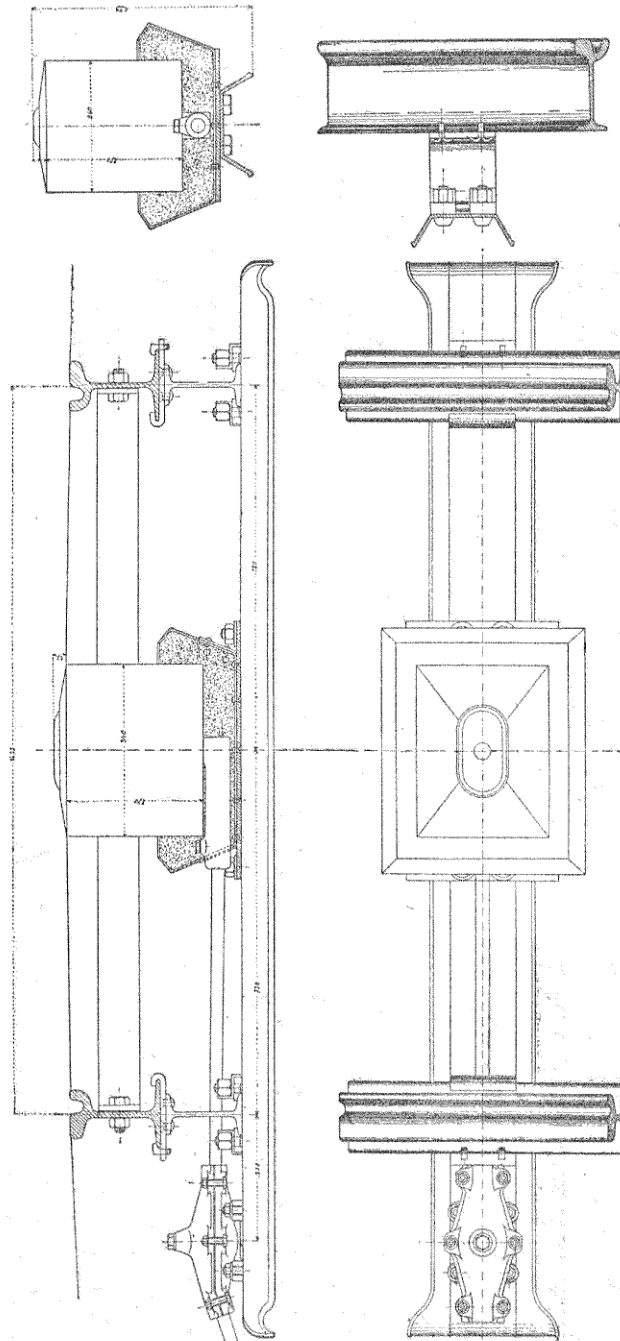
Coupes et plan de la voie Schuckert au droit d'un plot.
